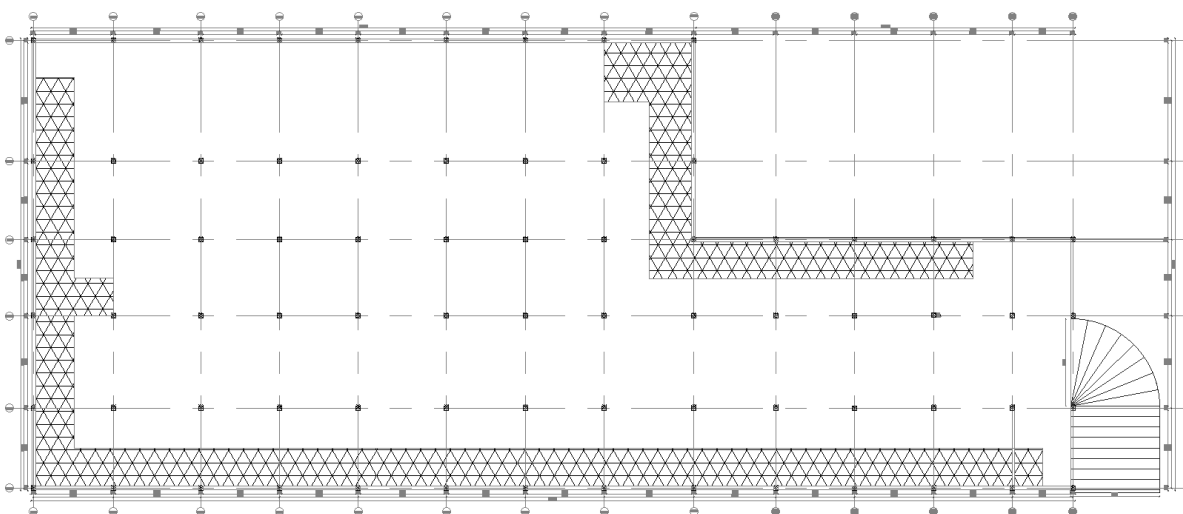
Planta arquitectónica, área achurada de placa de contra piso a demoler, fuente propia
